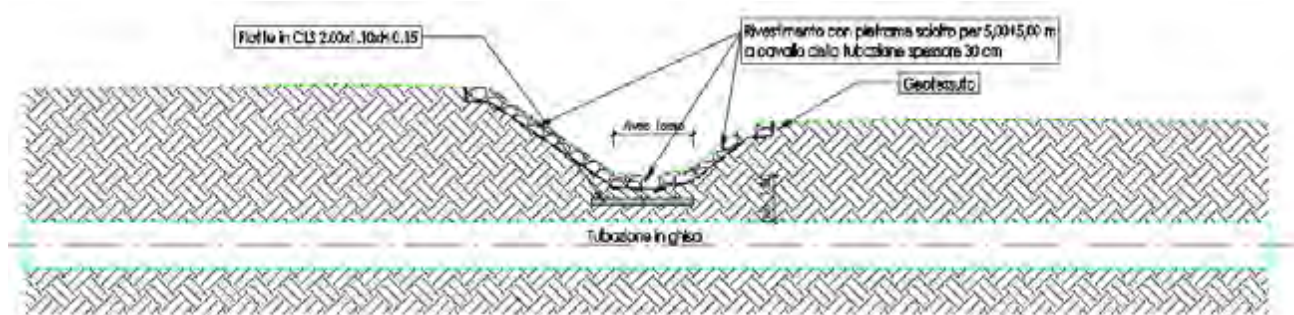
Sezione tipo di attraversamento in corrispondenza di fossi secondari.
